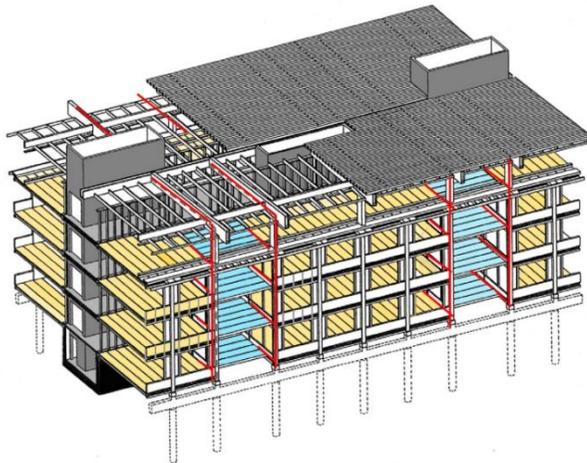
Escuela Suiza, placas prefabricadas de madera distribuidas sobre estructuras individuales con orientación alternada¹²
